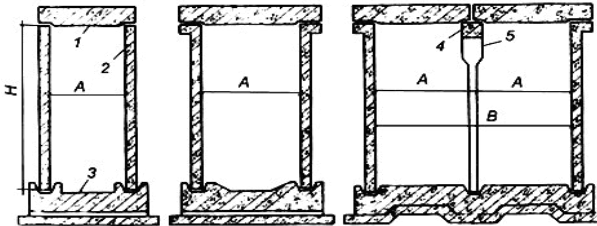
Збірні залізобетонні прохідні тунелі:
